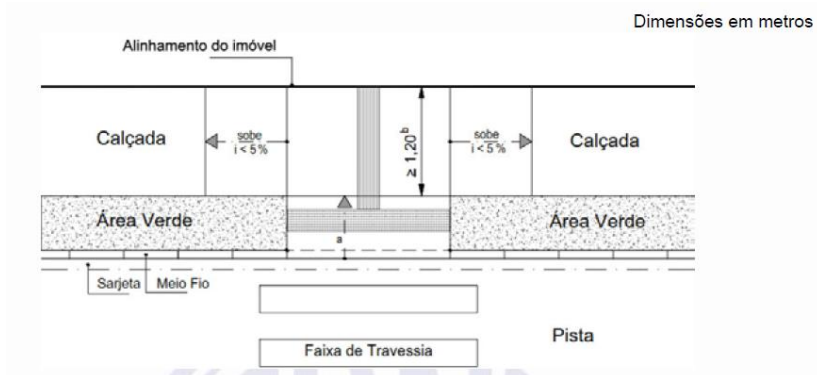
Rebaixamento de calçada entre canteiros – Exemplo
